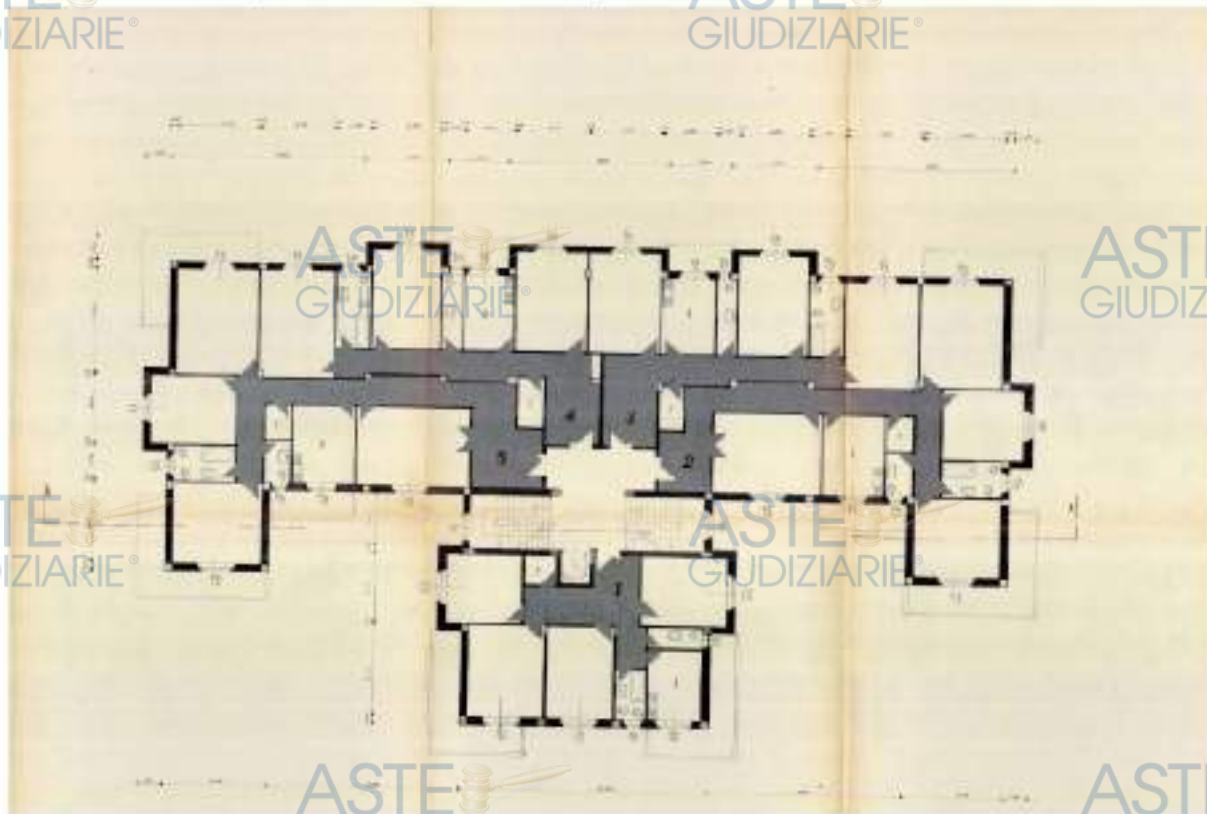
Planimetria del piano tipo dello stabile in oggetto.
